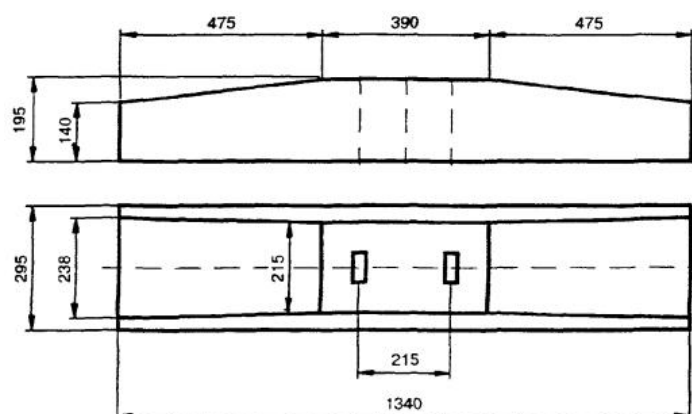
Железобетонная полушпала ПШН4-13-325-1
